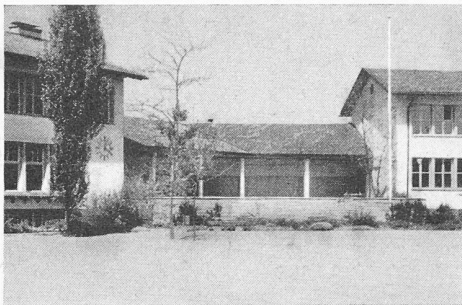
Transformatorenstation «Schulhaus» in Adliswil (Baujahr 1949). Die Station befindet sich in der Rückwand der Pausenhalle, unter deren Dach die Ventilations-schlitze sichtbar sind
